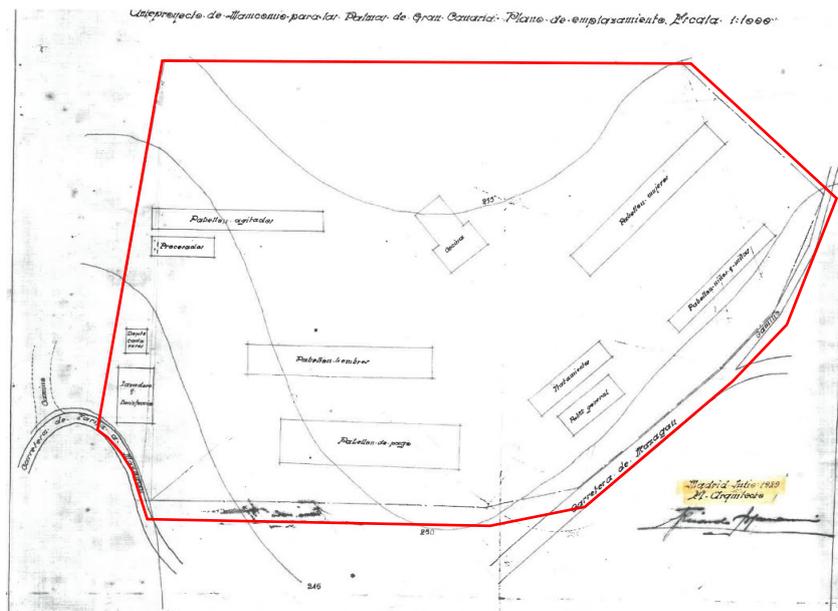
Anteproyecto de Manicomio. Plano de emplazamiento, por el arquitecto Ricardo Macarrón y Piudo. Julio de 1929.
